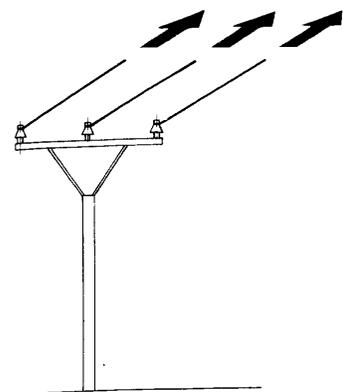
Esfuerzos longitudinales debidos a la tracción de los conductores, sobre un apoyo de principio de línea.
